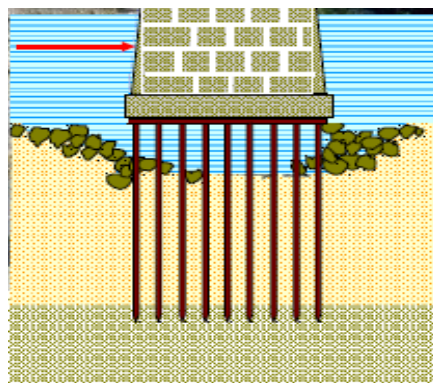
Schéma illustrant le phénomène d'affouillement du sol autour d'une fondation profonde de la pile d'un pont
